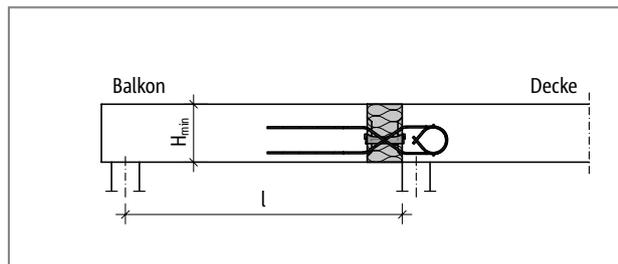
Schöck Isokorb® Typ QXT+QXT: Statisches System (Typ QXT10+QXT10 bis QXT40+QXT40)
